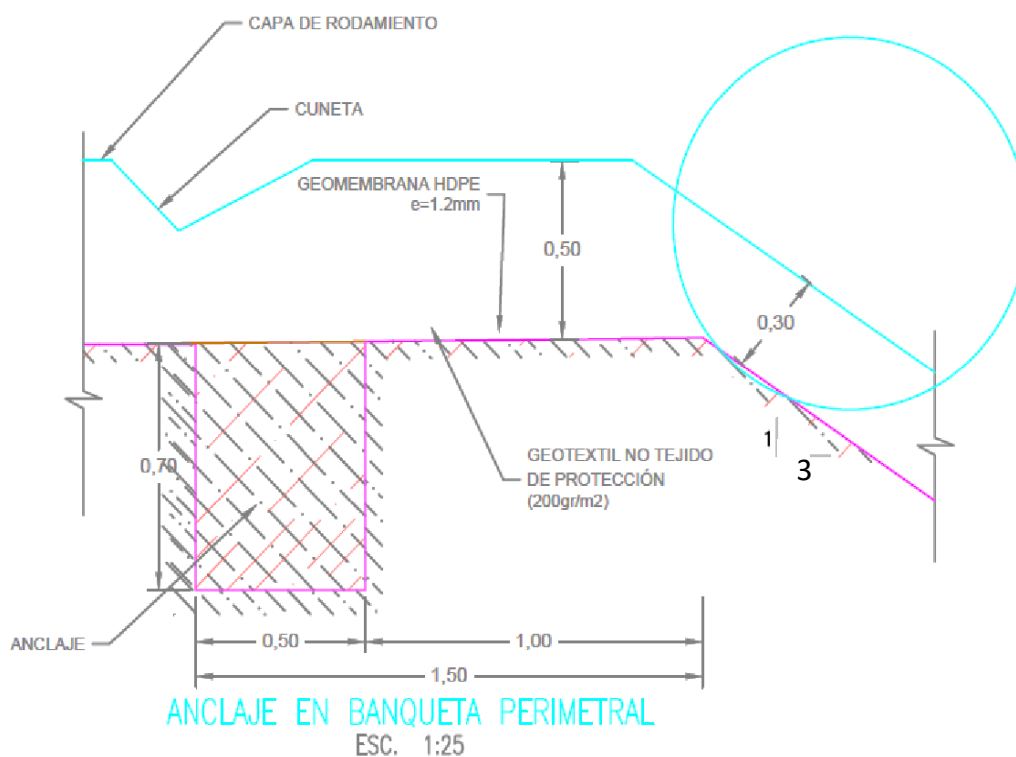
Típico de zanja de anclaje de impermeabilización de fondo.
